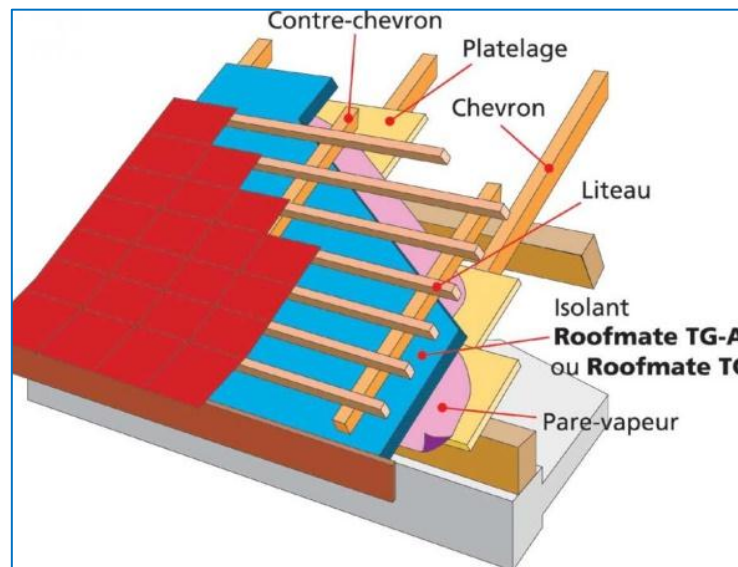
La construction des panneaux sandwichs dans bâtiments[7].
